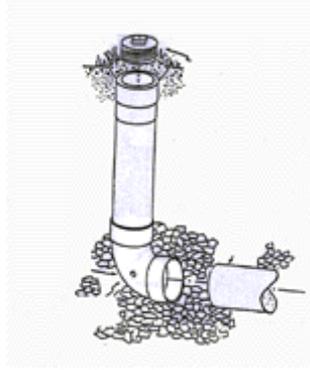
Détail d'un embout de rampe facilitant le contrôle de la pression du réseau ou un éventuel
